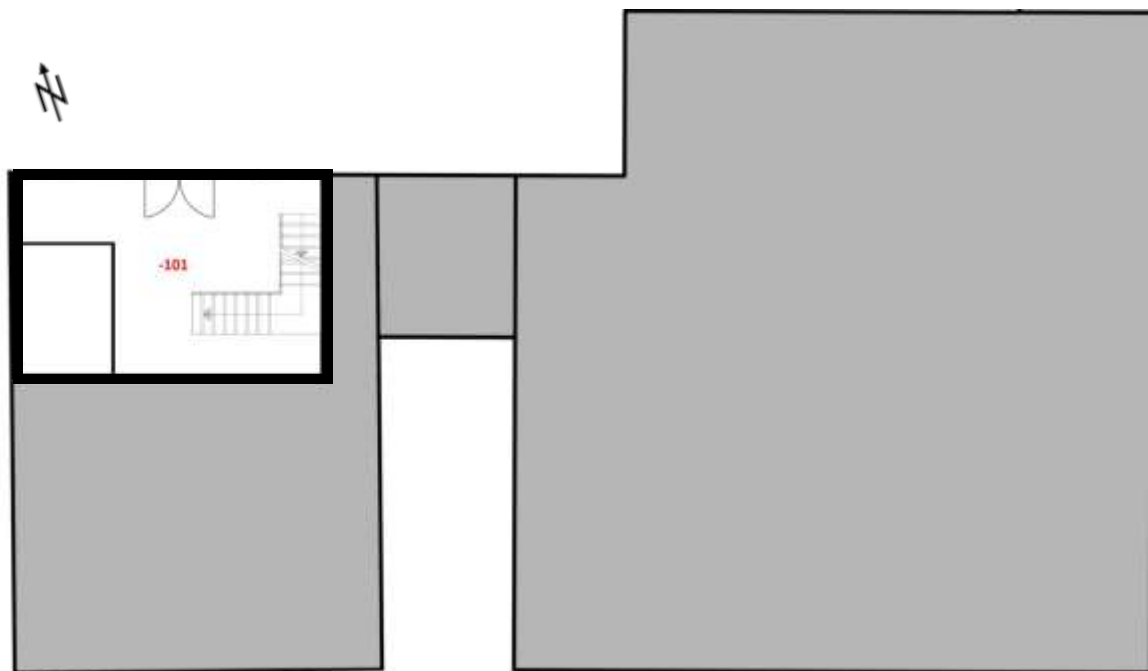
Schematischer Grundriss Keller. Bearbeitung IBID.
